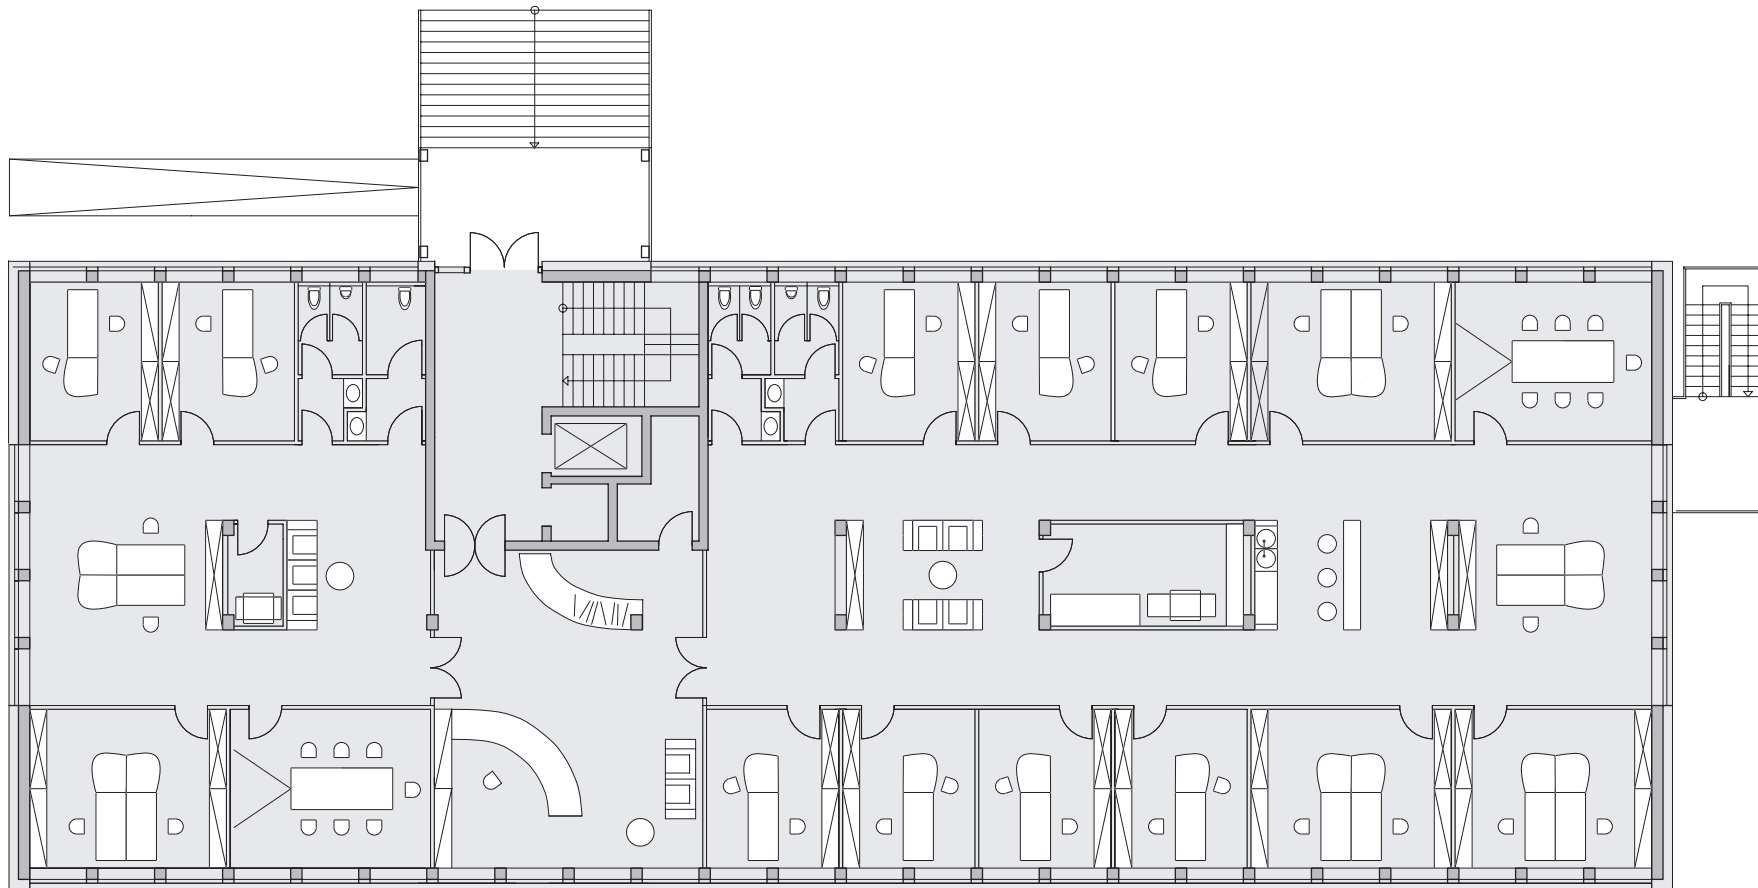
Grundriß EG (Sanierungsstudie),
